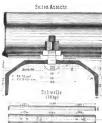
Eiserner Querschwellen-Oberbau. [System Heindl, 1882.]
